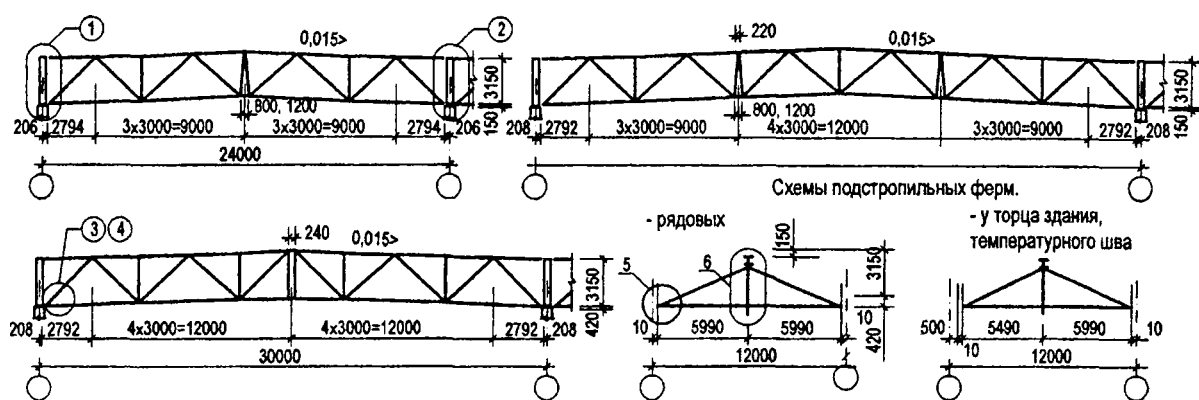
Геометрические схемы ферм из широкополочных двутавров
